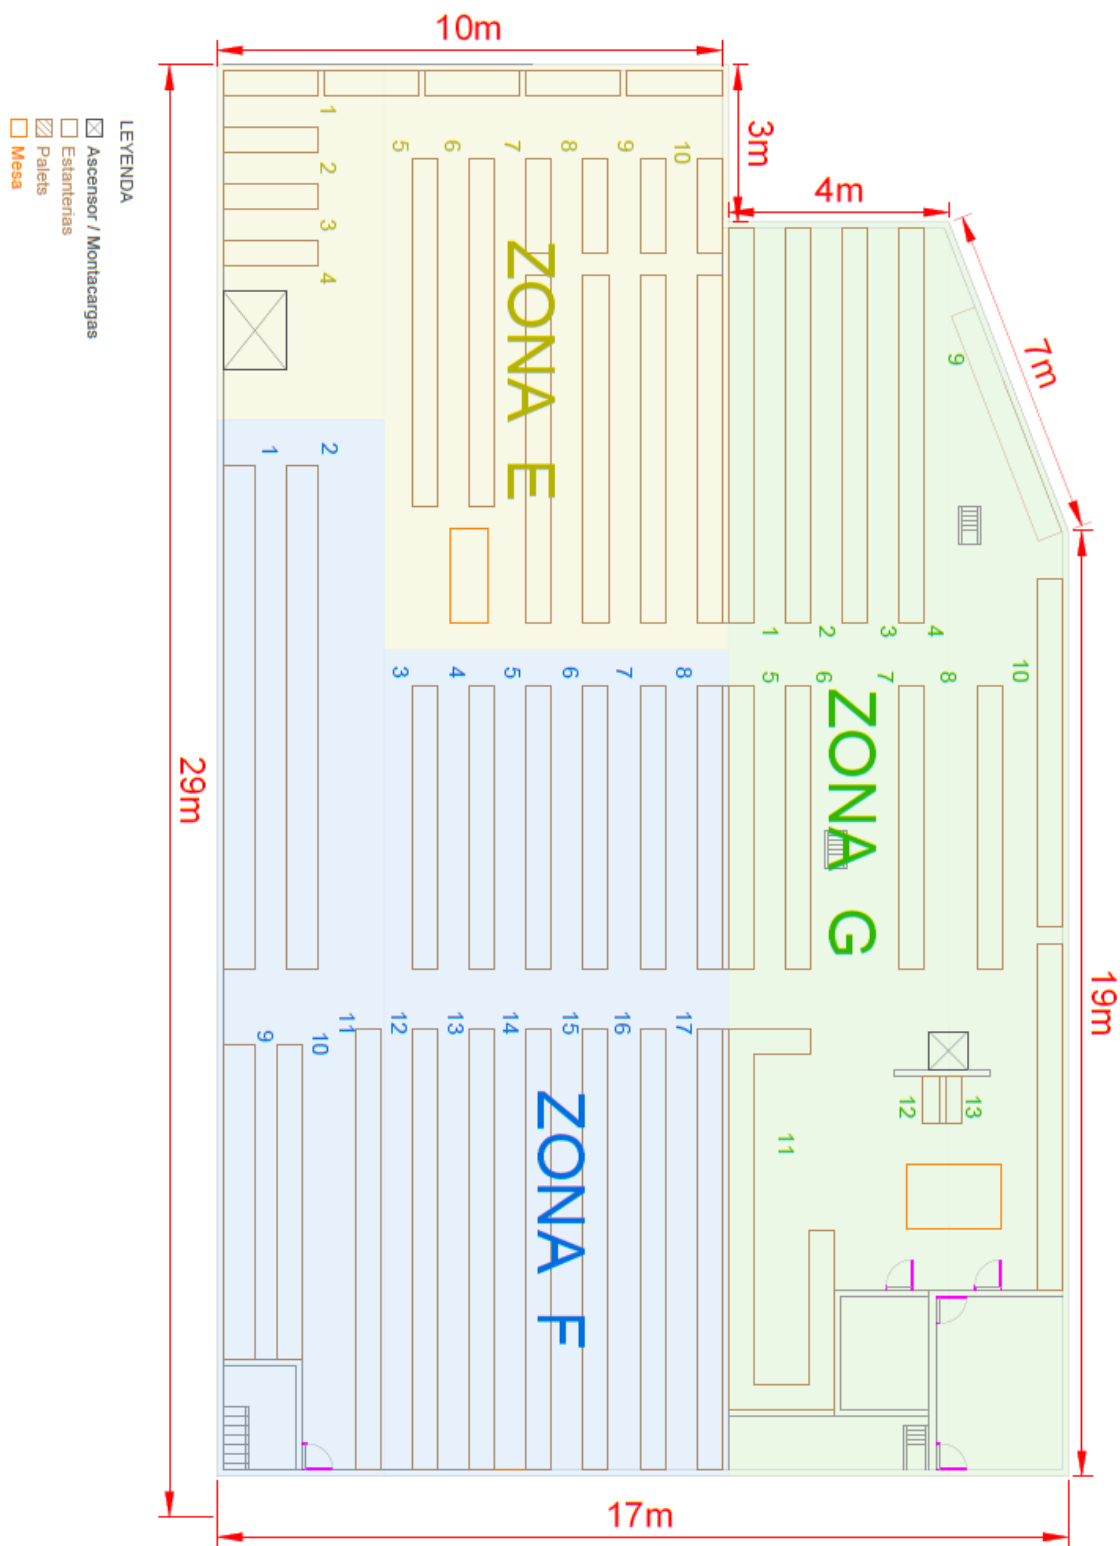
Imagen del plano de la primera planta por zonas (Anexo D: P005)
